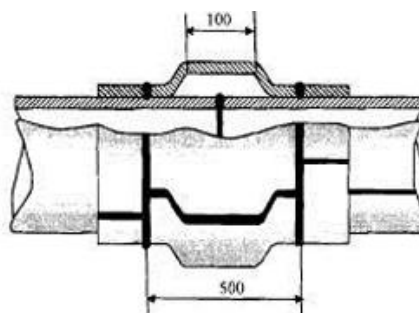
Муфта П4 - Муфта галтельная с короткой полостью для ремонта сварных кольцевых швов
